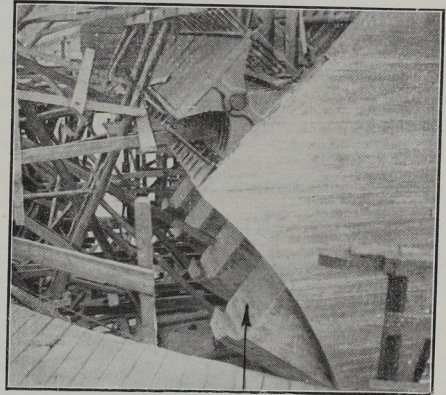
Premier étape après construction de la pile, mise en place et fixation des rotules de pied des arches (vue de face et de haut). On voit les sommiers en béton pour l'appui des cintres
